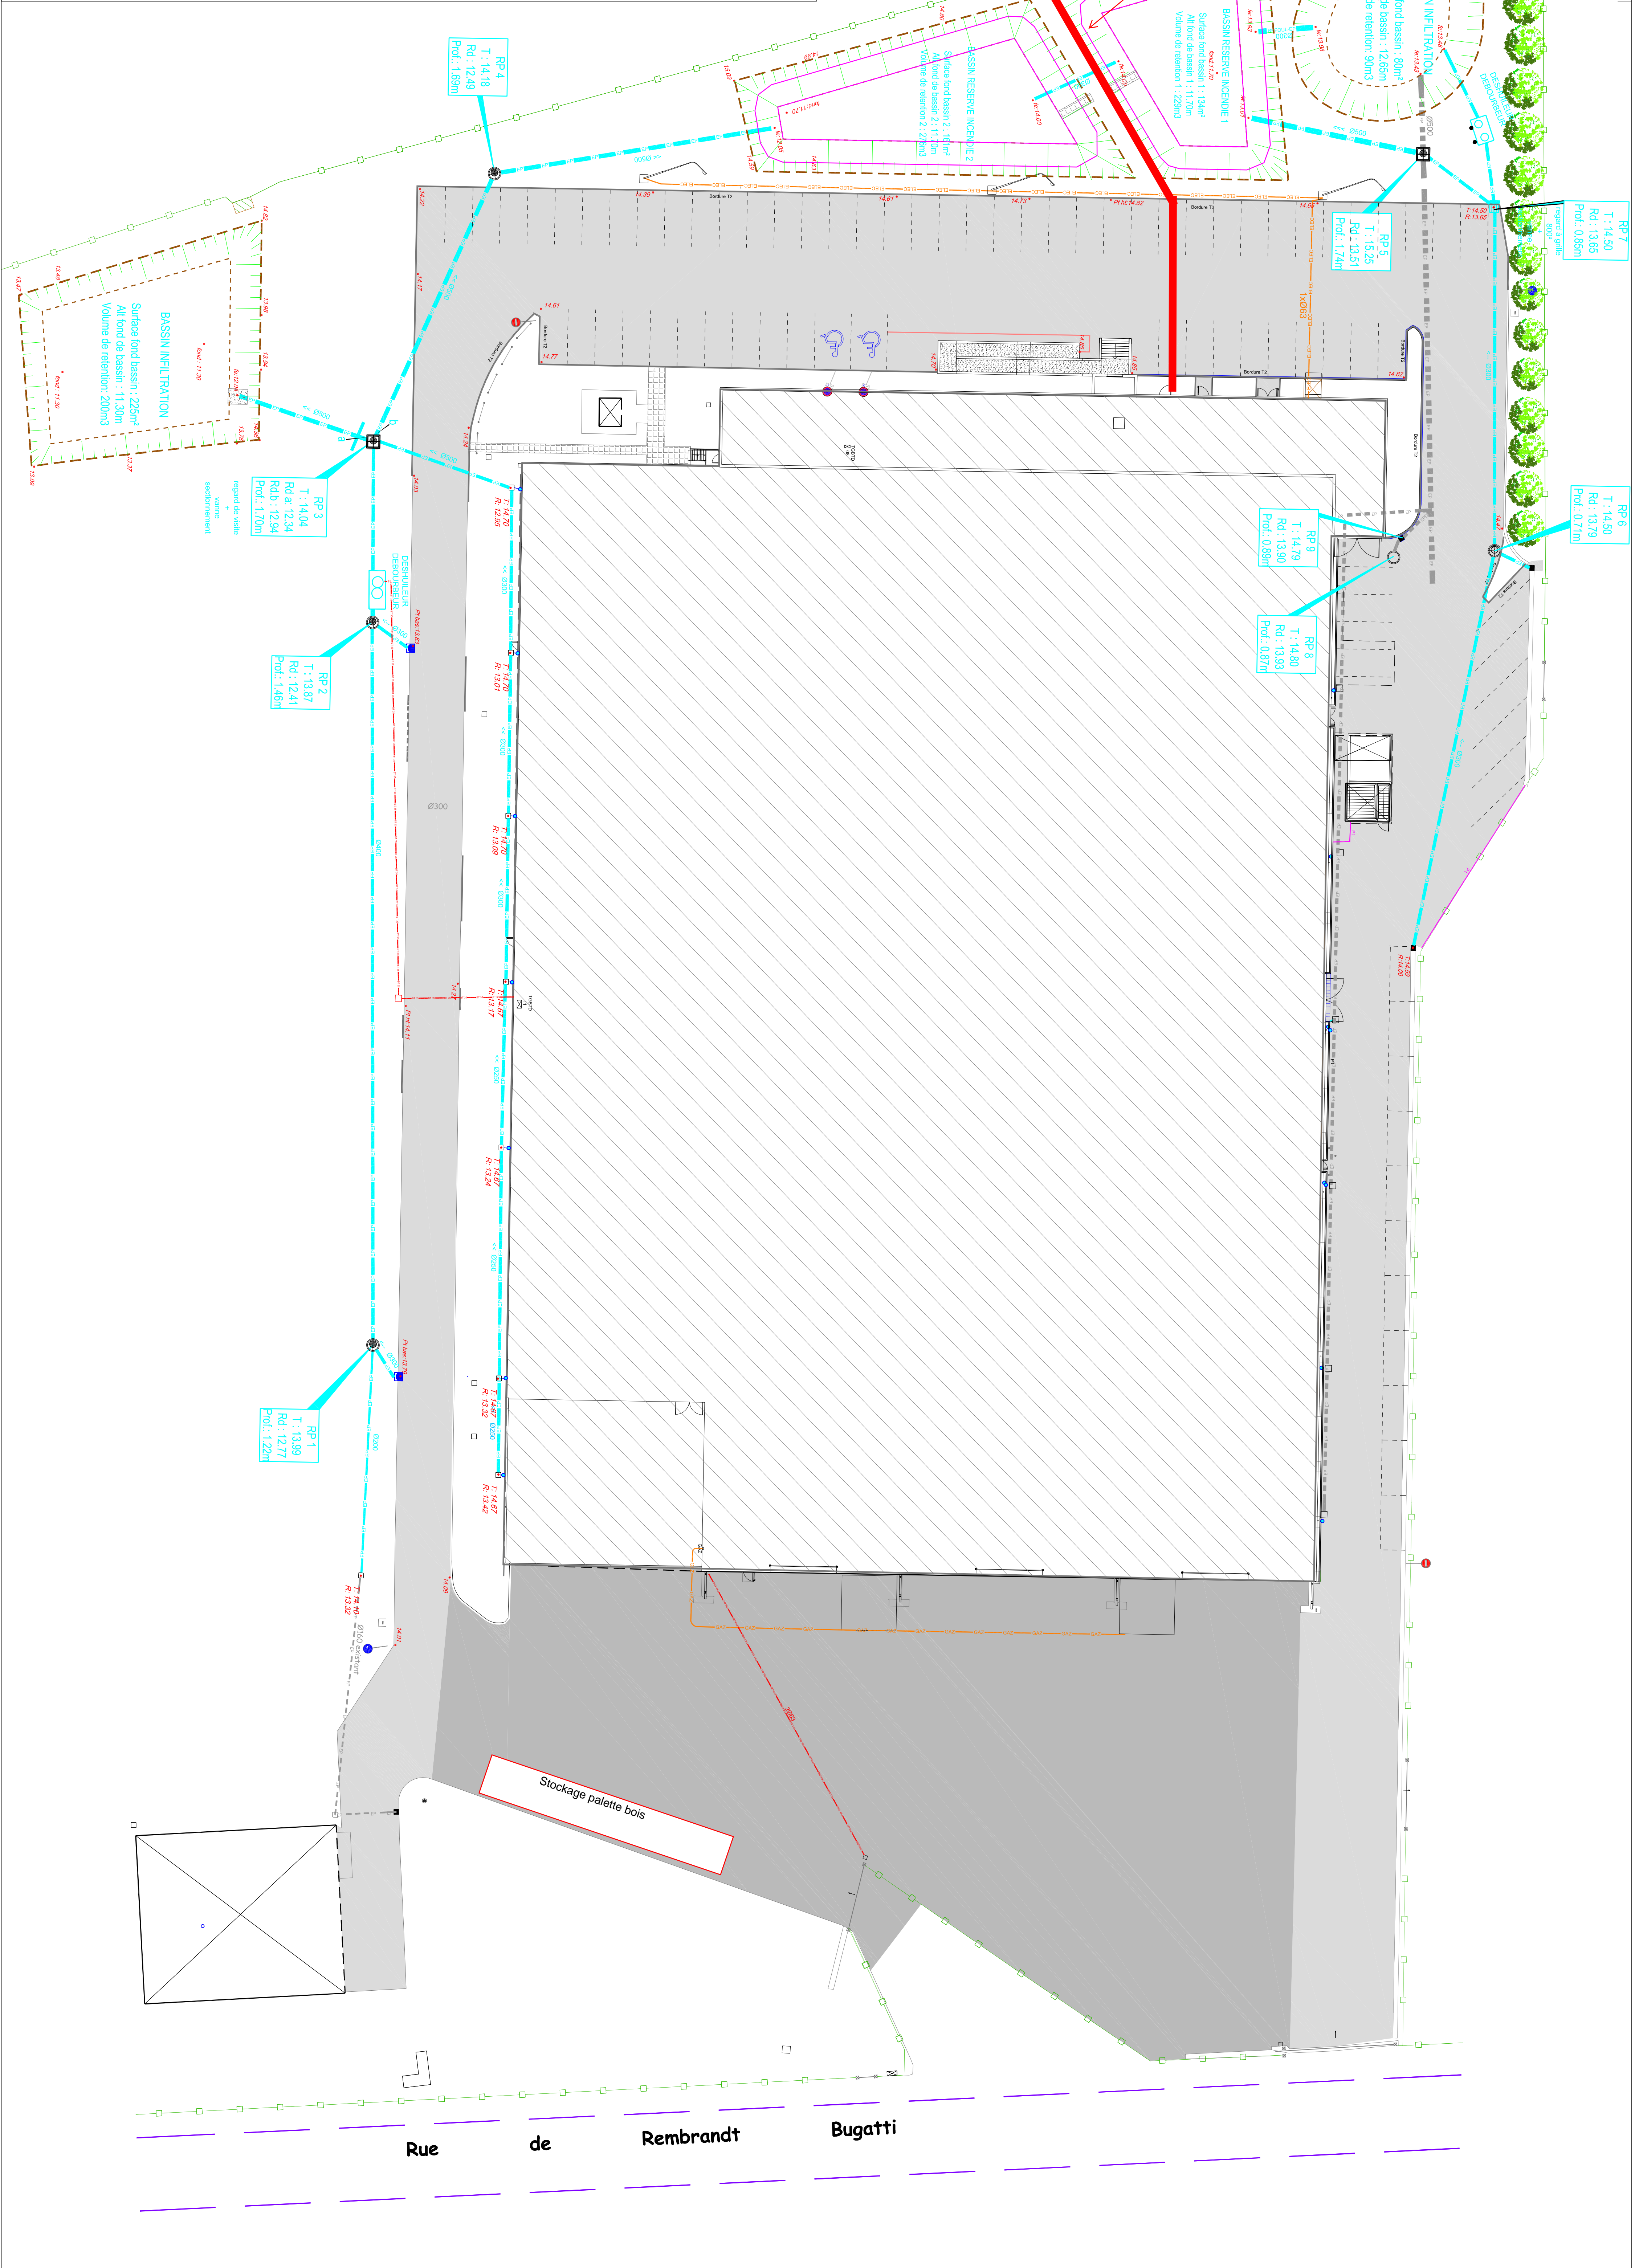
FIGIERS : CHIRBAUX/PROJET CAP PROFILE PLAN REC
